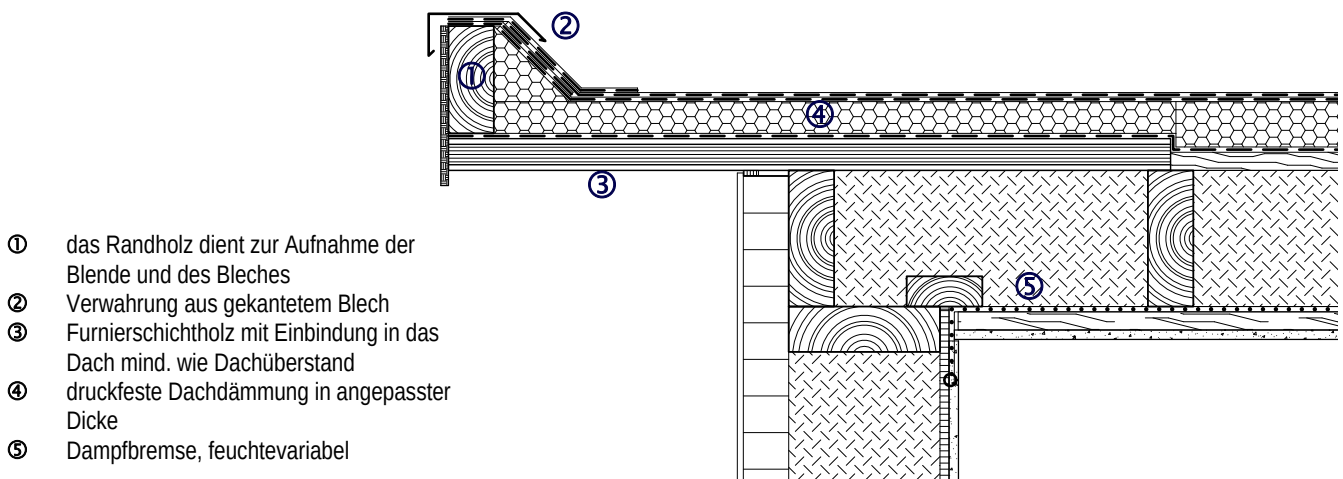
Für ein Flachdach mit Zusatzdämmung wird hier der Dachrand dargestellt. Soll die Dachkante sehr schlank bleiben kann mit einer Furnierschichtholzplatte ③ der Überstand tragend hergestellt werden.
